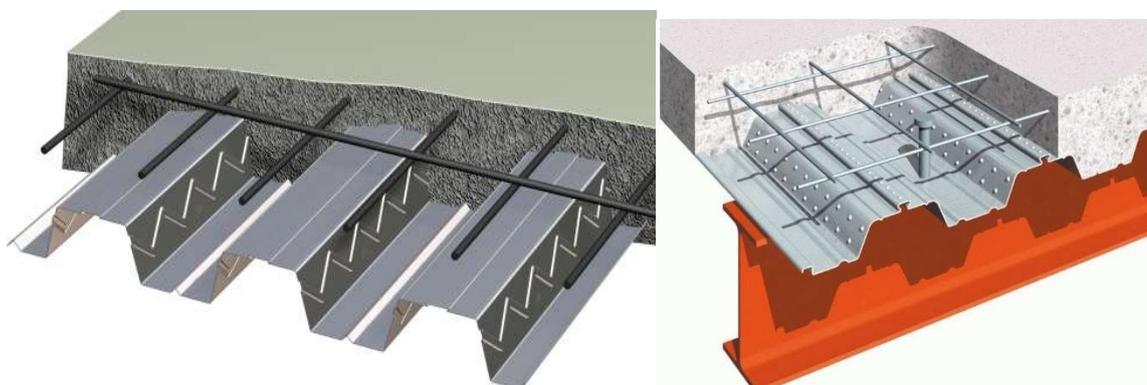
Монолитные перекрытия с несъемной опалубкой из профнастила
